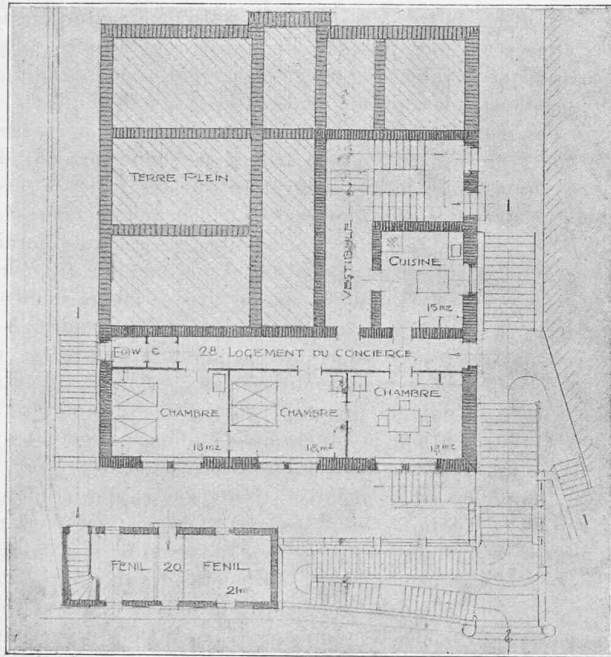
Plan du sous-sol inférieur. — 1 : 300.
